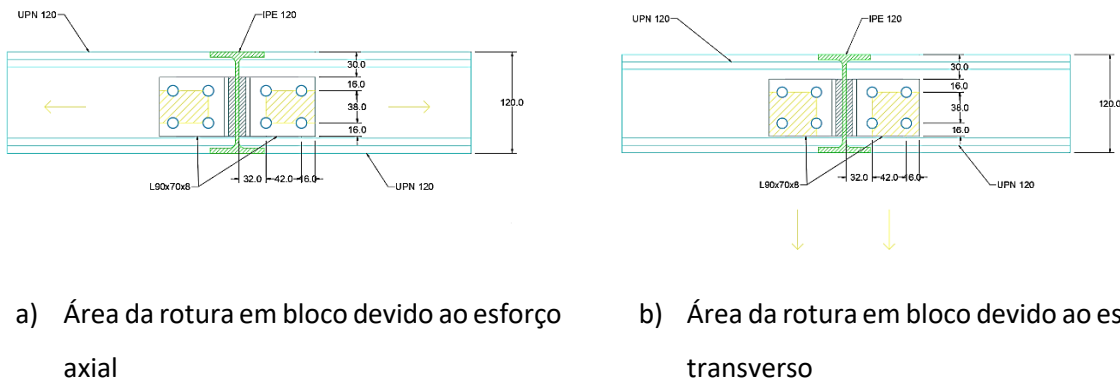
Área considerada para a rotura em bloco da ligação metálica L12
